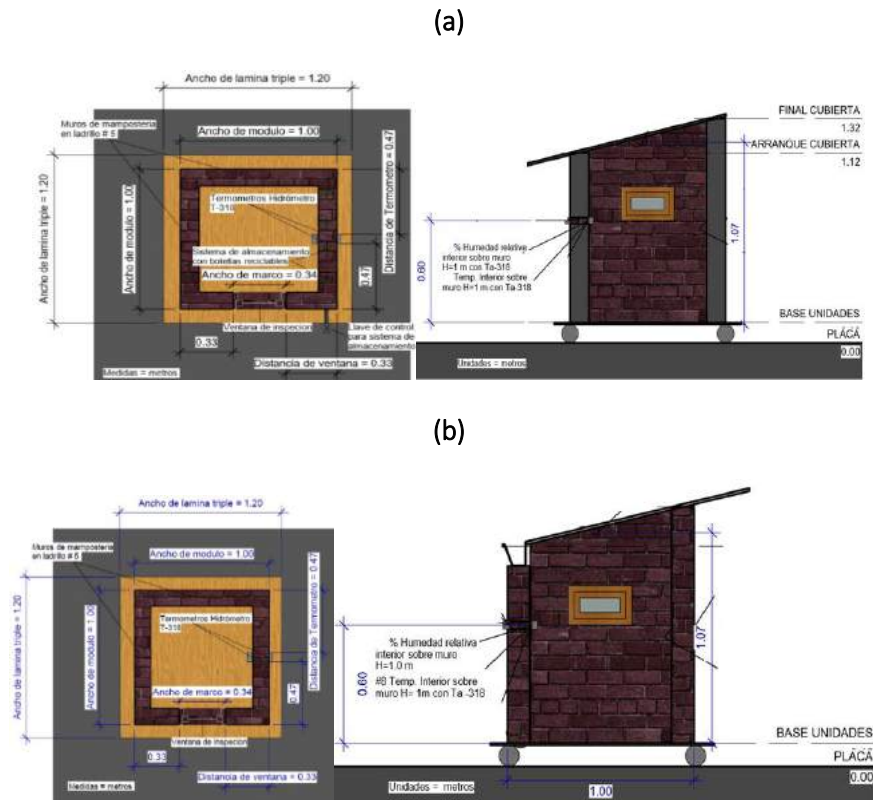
Planos de planta y corte de módulo modificado, (b) Planos de planta y corte de modulo convencional.
